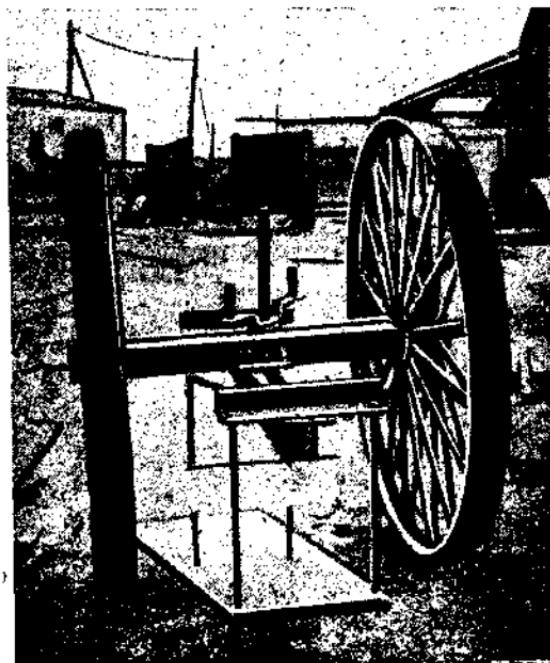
Тележка с домкратом для перевозки готовых железобетонных элементов.
